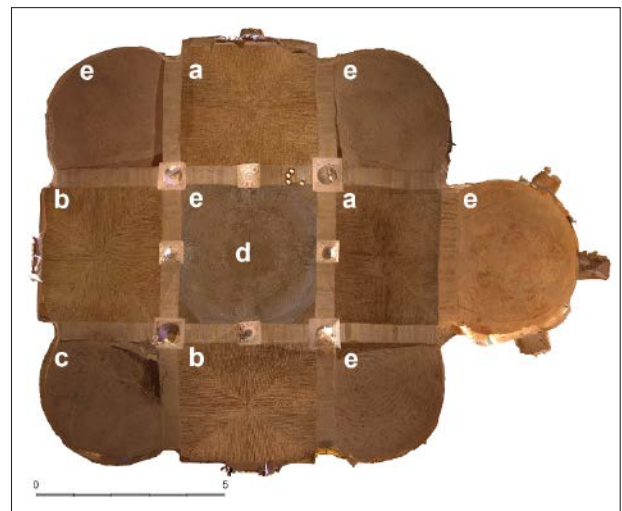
Fotogrametría de las cubiertas interiores (Archivo ICAC-UDG). a) restauración de J. Arnella (1616); b) restauración de J. Arnella (1617); c) restauración de J. Arnella (1617) y revoque de mortero de Puig i Cadafalch (1929); d) cegado de la linterna por Puig i Cadafalch (1929); e) estructura original.
